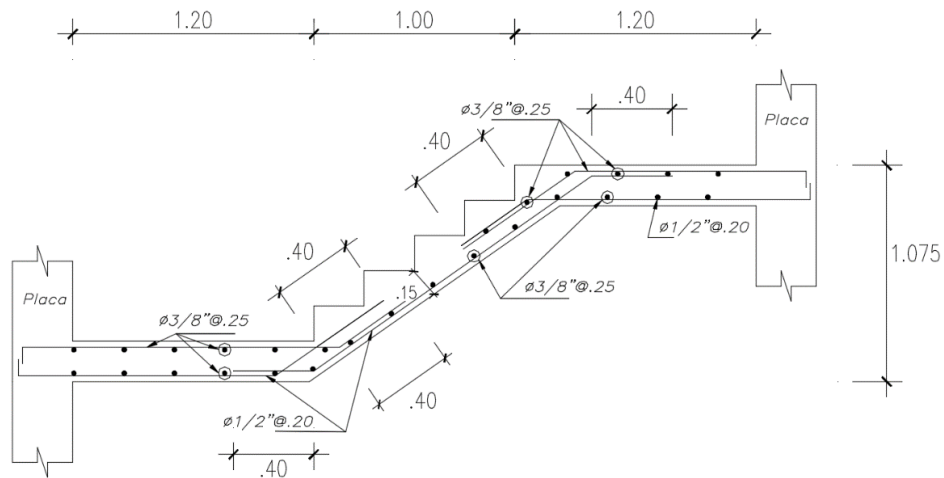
Detalle del segundo tramo de la escalera típica
